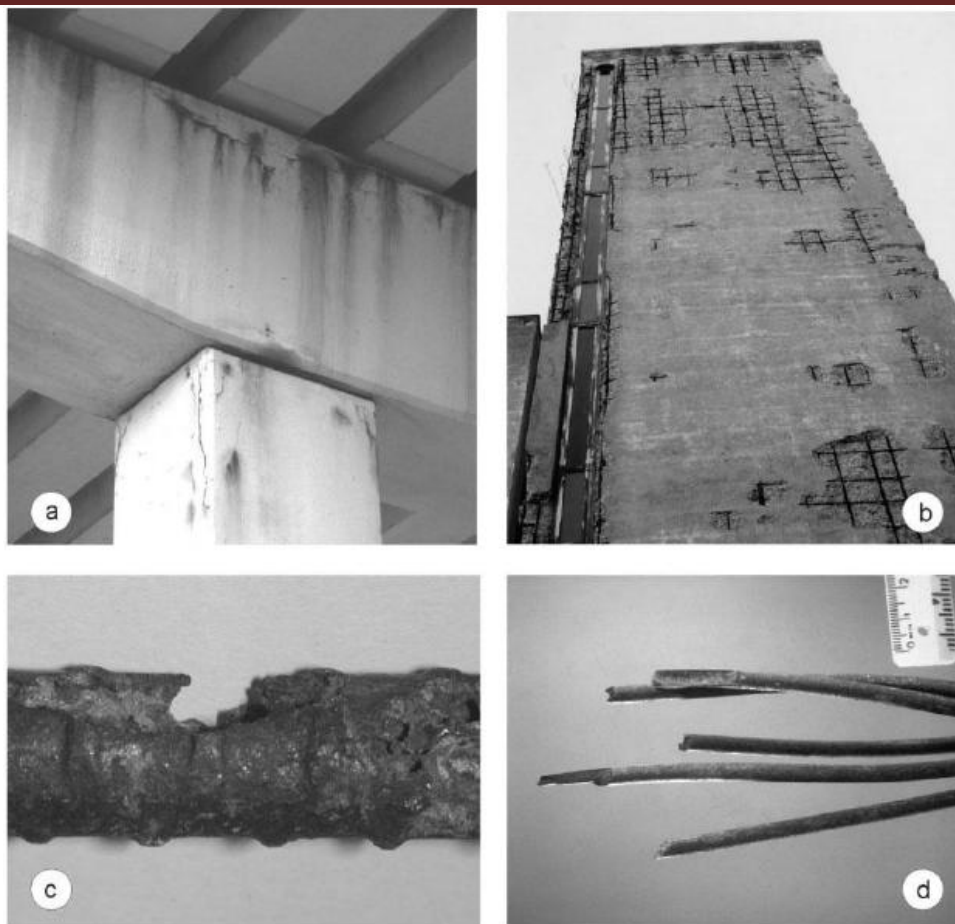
Exemples de conséquences de la corrosion de l'acier dans le béton: a) fissuration de la colonne et de la traverse; b) effritement et délamination de la couche de béton; c) réduction de la section transversale de la barre d'armature due à la corrosion par piqûre; d) rupture fragile des câbles de précontrainte due à la fragilisation par l'hydrogène [100]
